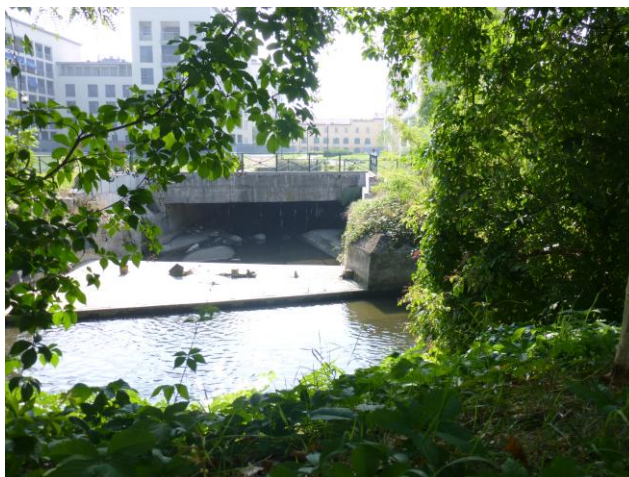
vista dell'imbocco della derivazione ex-Binda
